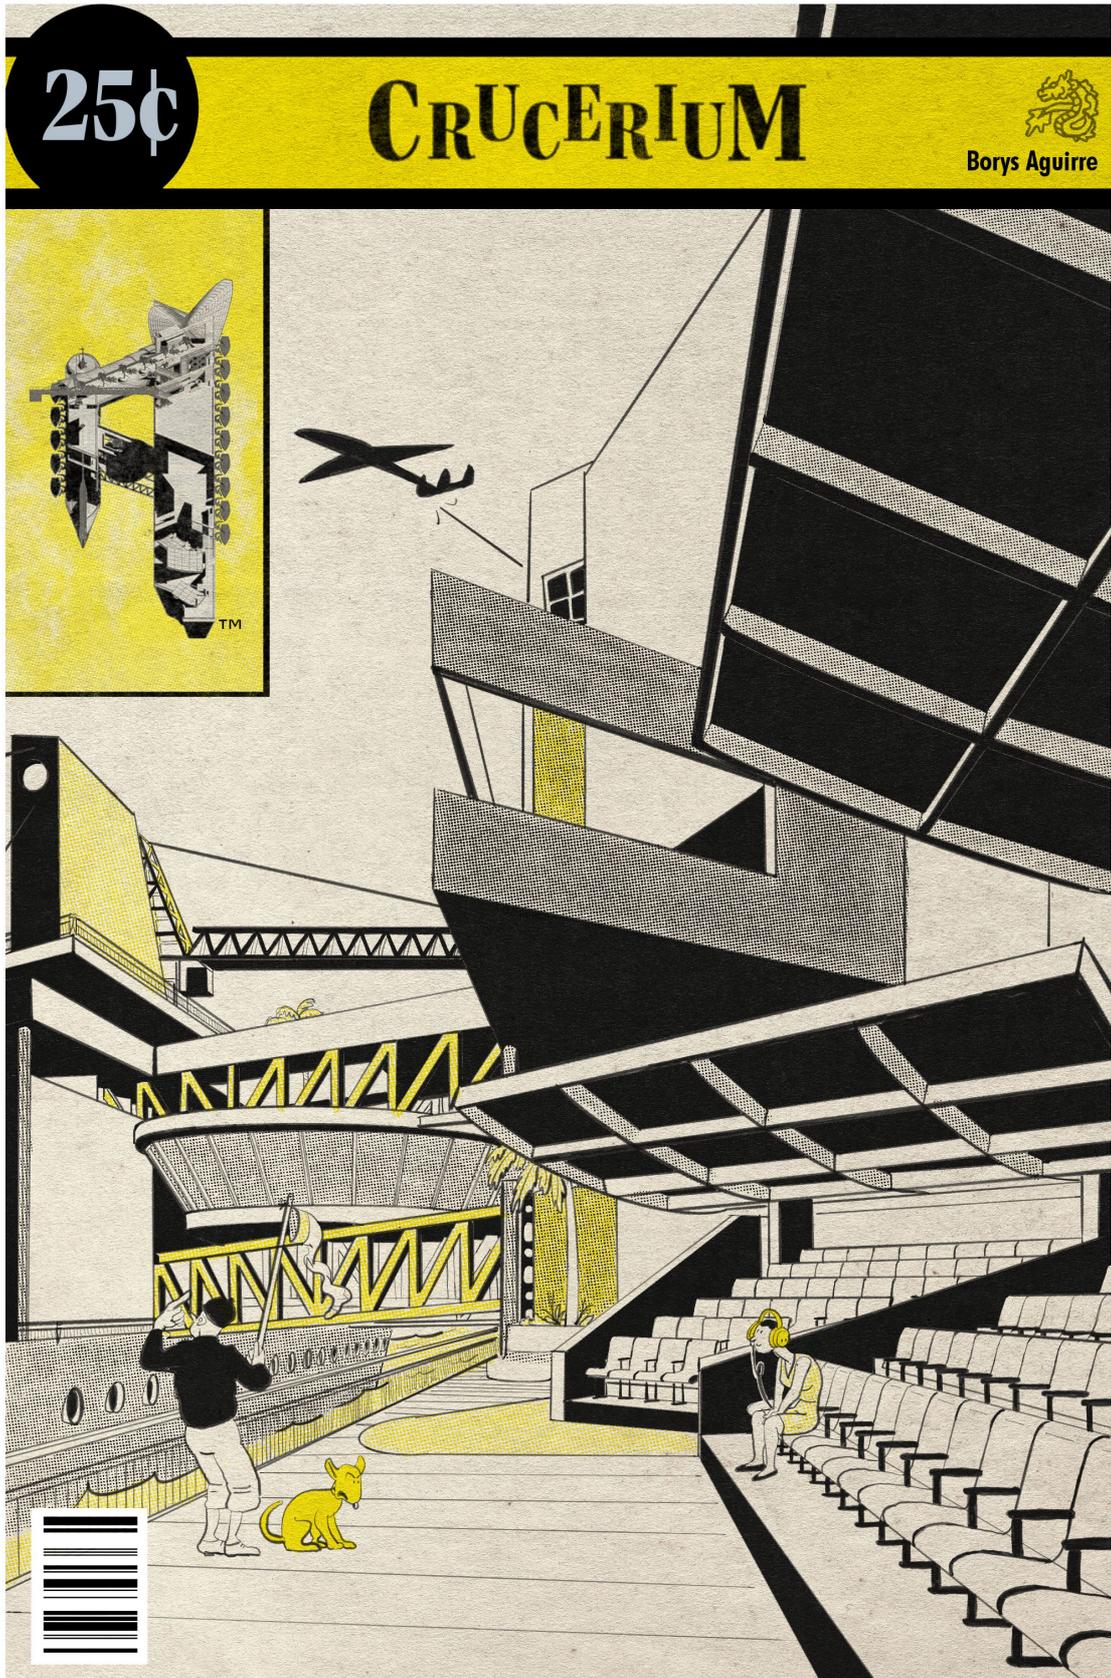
Vista deck Planta Baja, y Axonometría Frontal
